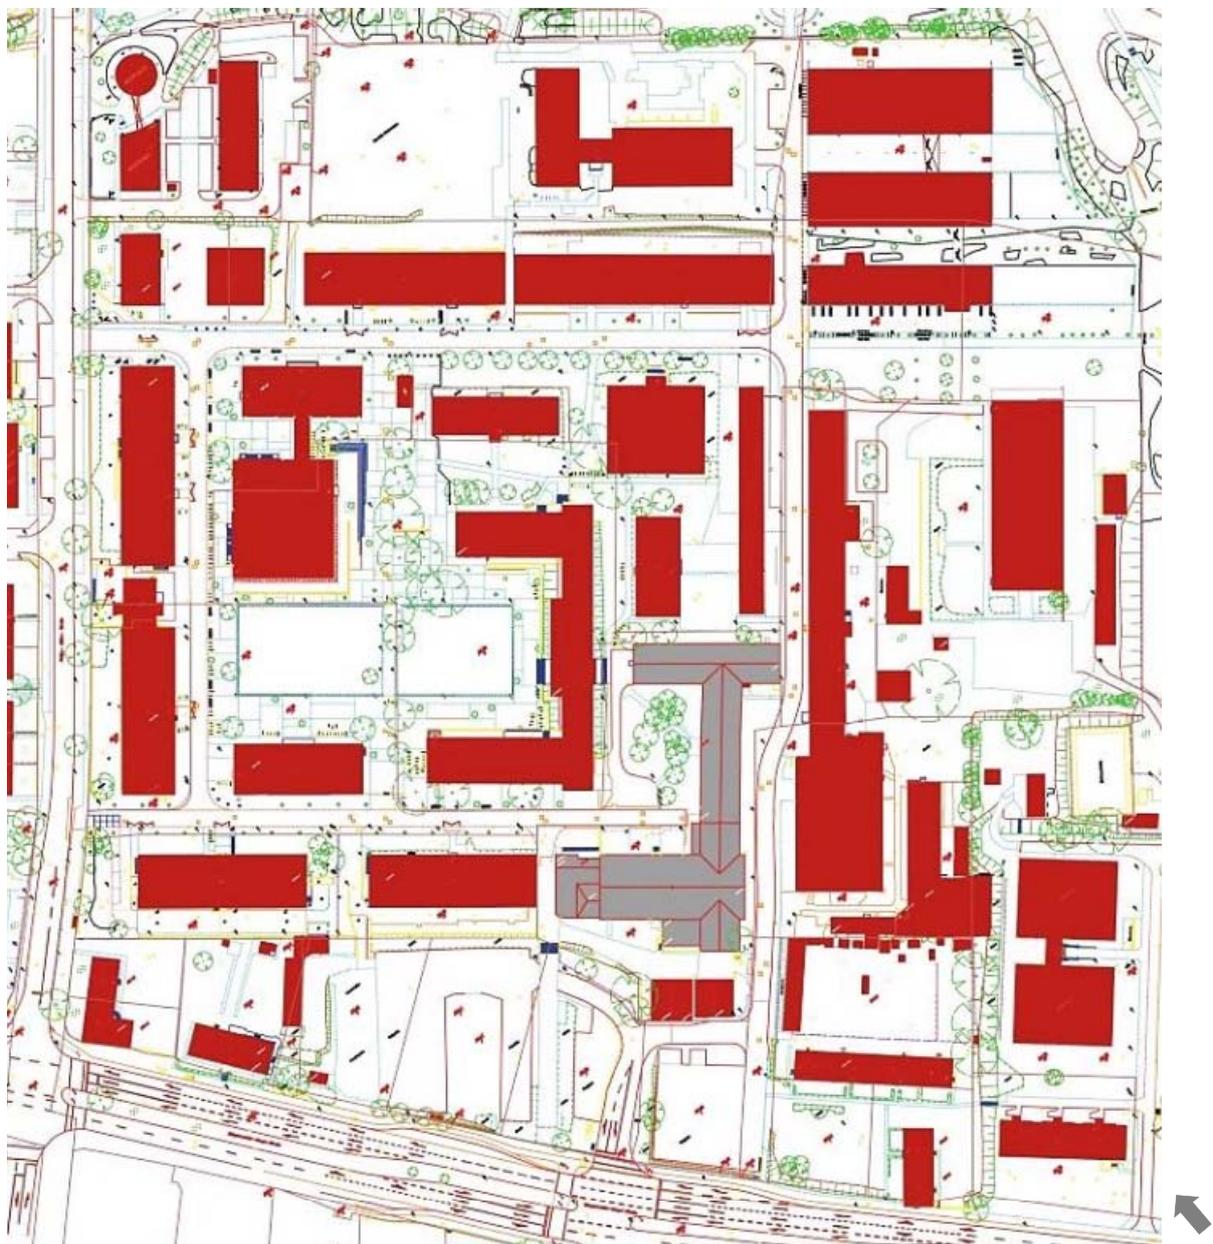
Lageplan Campus Hochschule Wismar, ohne Maßstab
